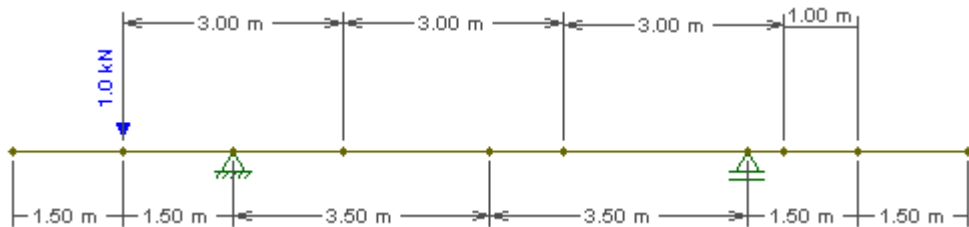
16- Aplicação da sobrecarga exercida no parapeito
